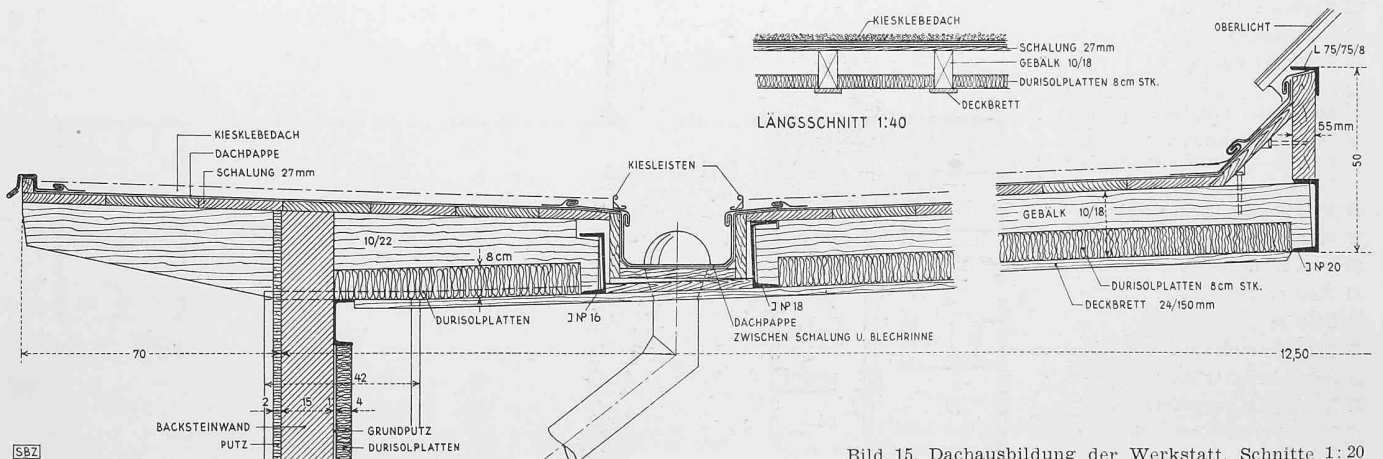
Dachausbildung der Werkstatt, Schnitte 1:20
